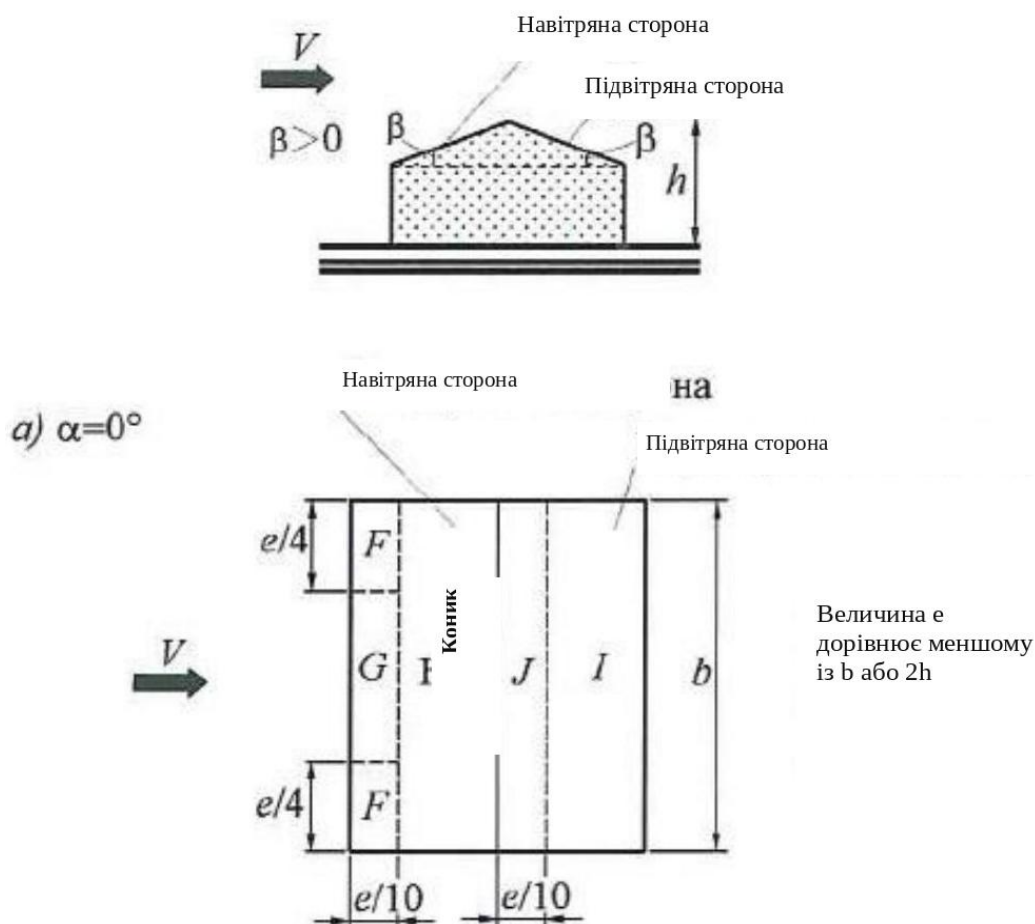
Вітрове навантаження на двосхилий дах будівлі
